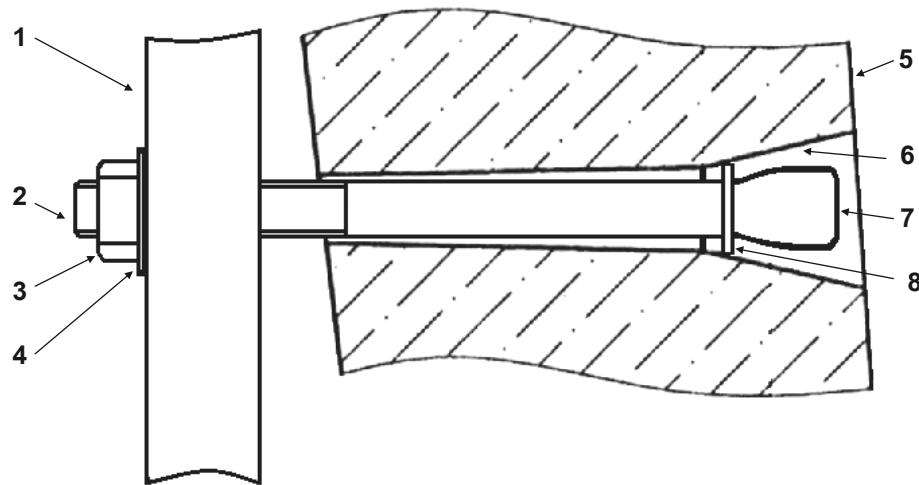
Крепление кронштейна типа ККП с помощью ёршей с резьбой:
